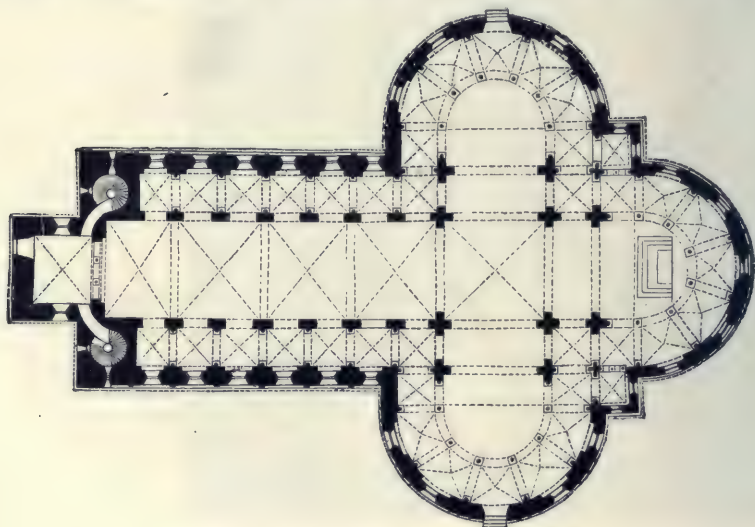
S. Maria im Kapitol zu Köln. Grundriss.
